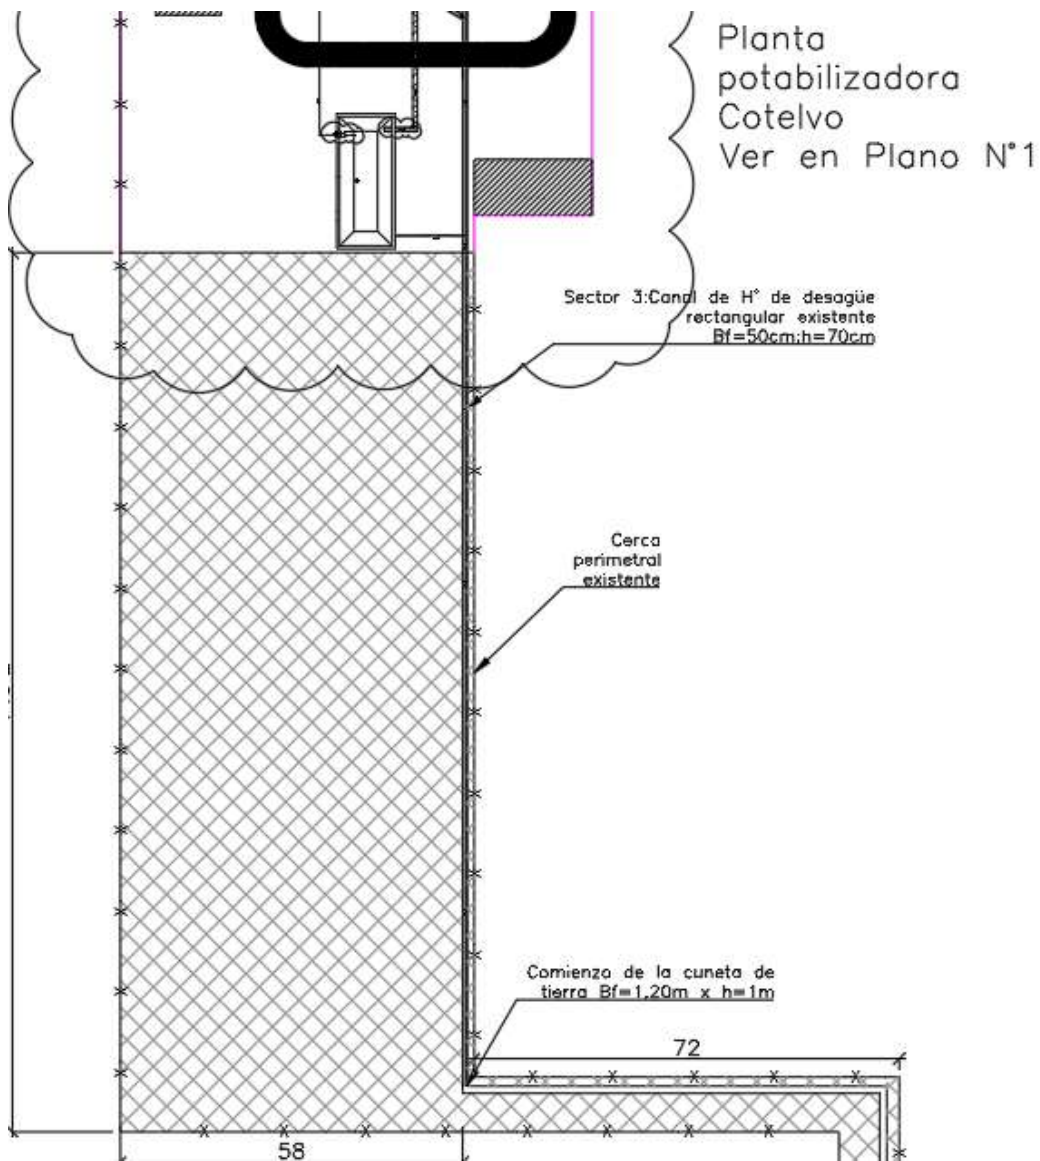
Unión entre en canal de mampostería y el canal de tierra existentes – Fuente de elaboración propia
